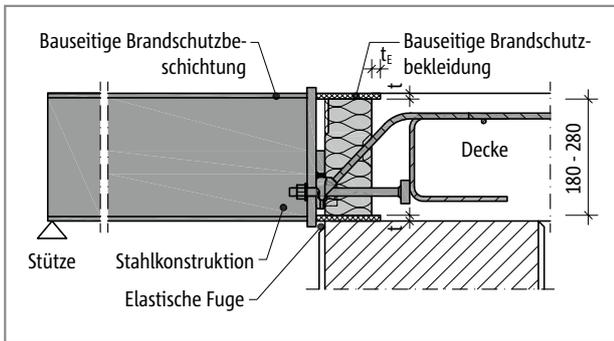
Schöck Isokorb® T Typ SQ: Bauseitige Brandschutzbekleidung T Typ SQ, brandschutzbeschichtete Stahlkonstruktion; Schnitt
